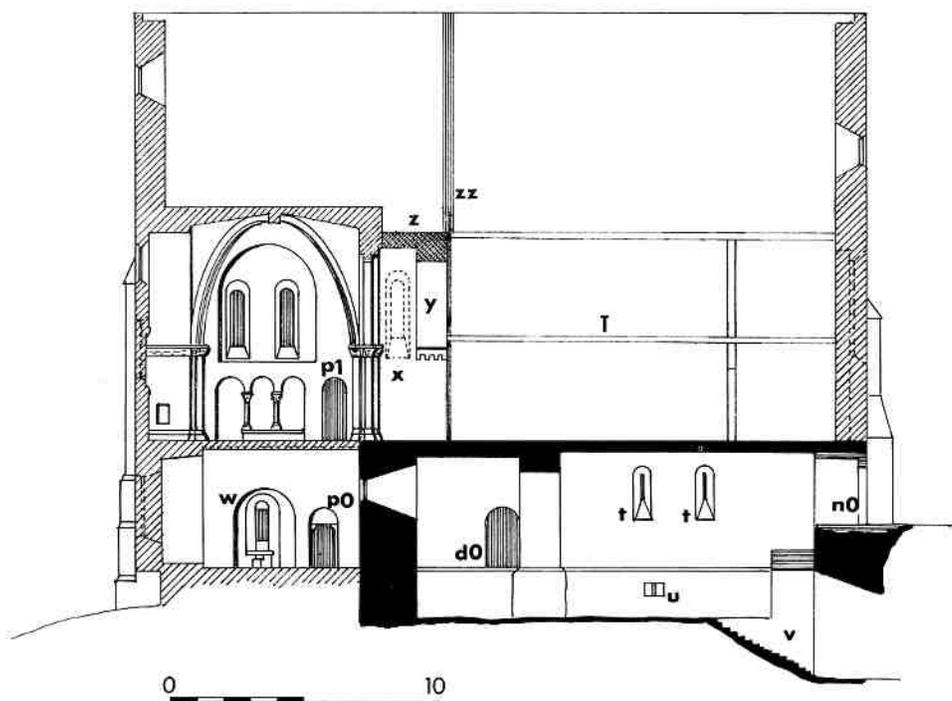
COUPE EST-OUEST DU BÂTIMENT DE LA CHAPELLE, DANS SON ÉTAT AVANT 1883
